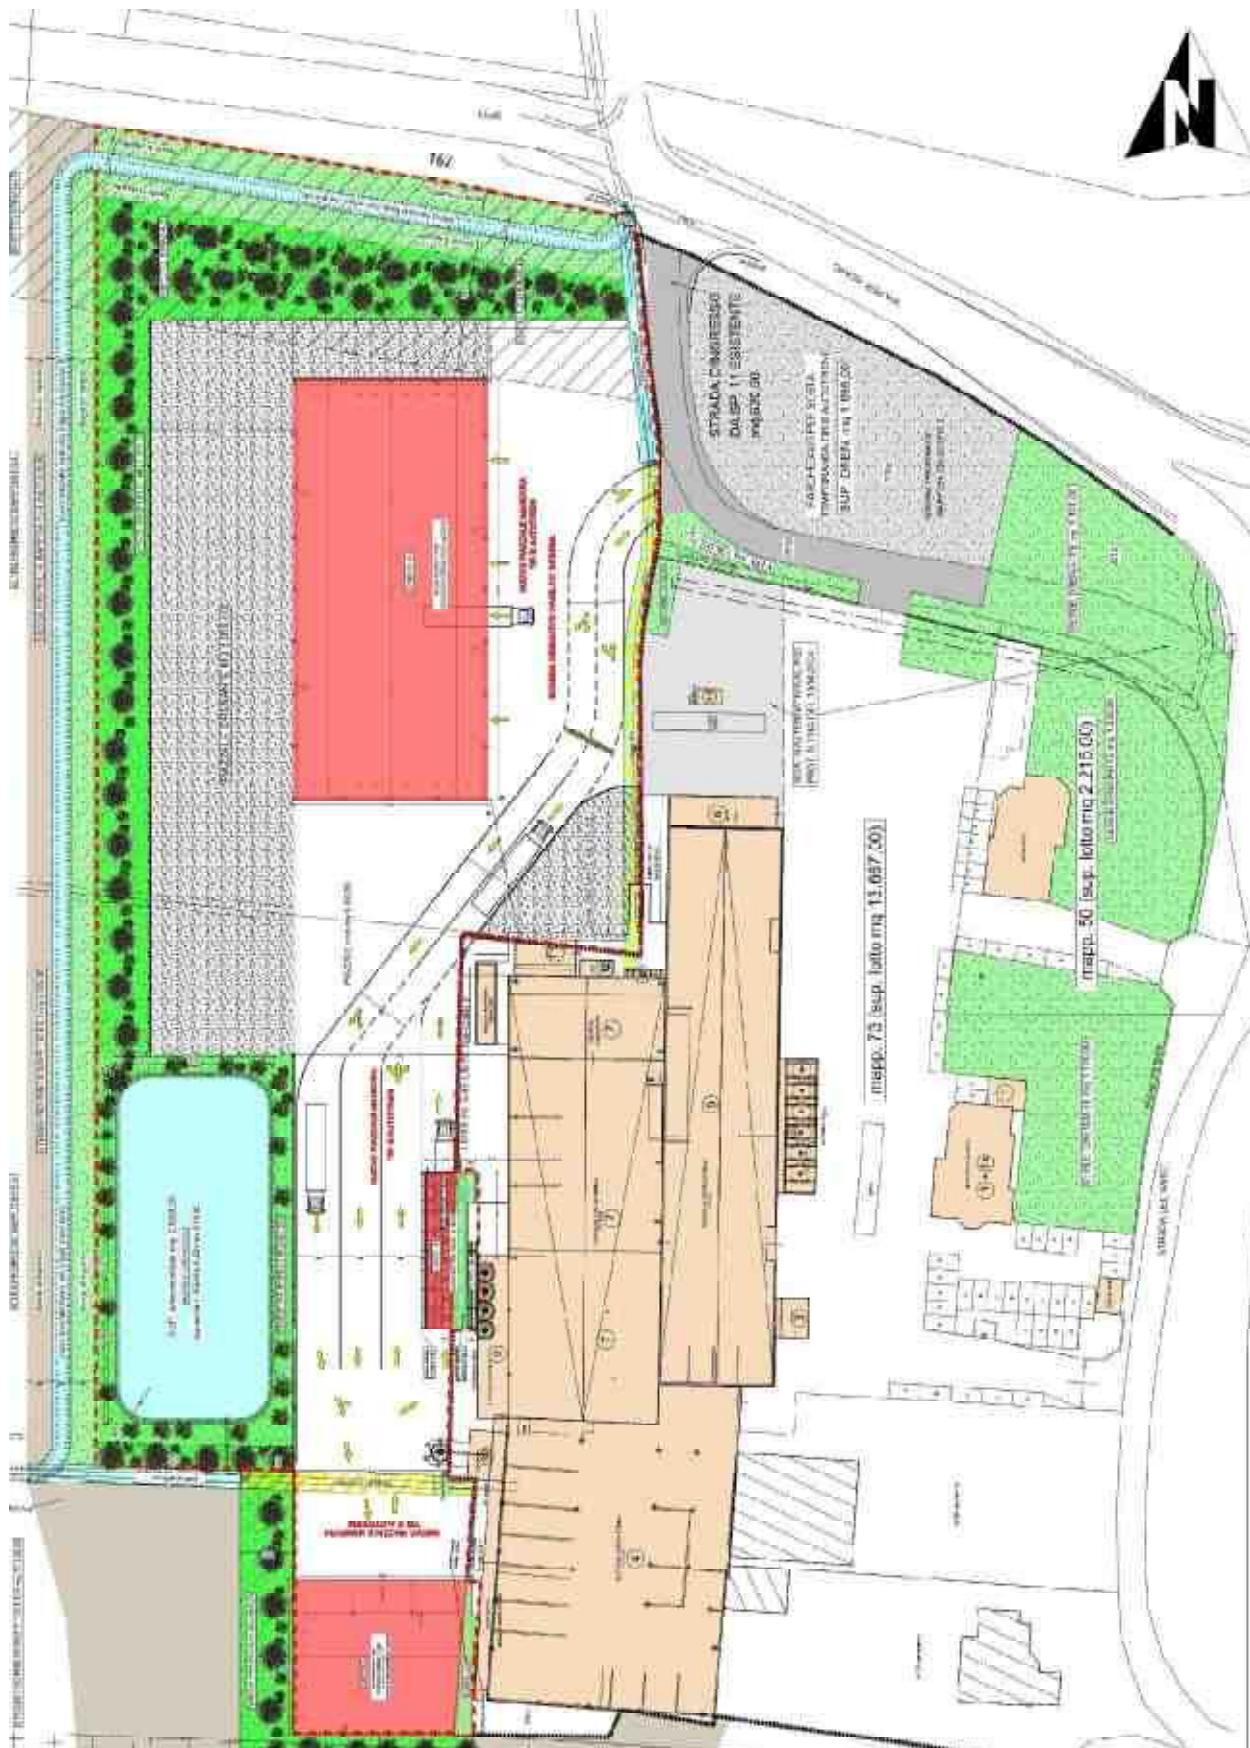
Planimetria di progetto dell'intervento di ampliamento
